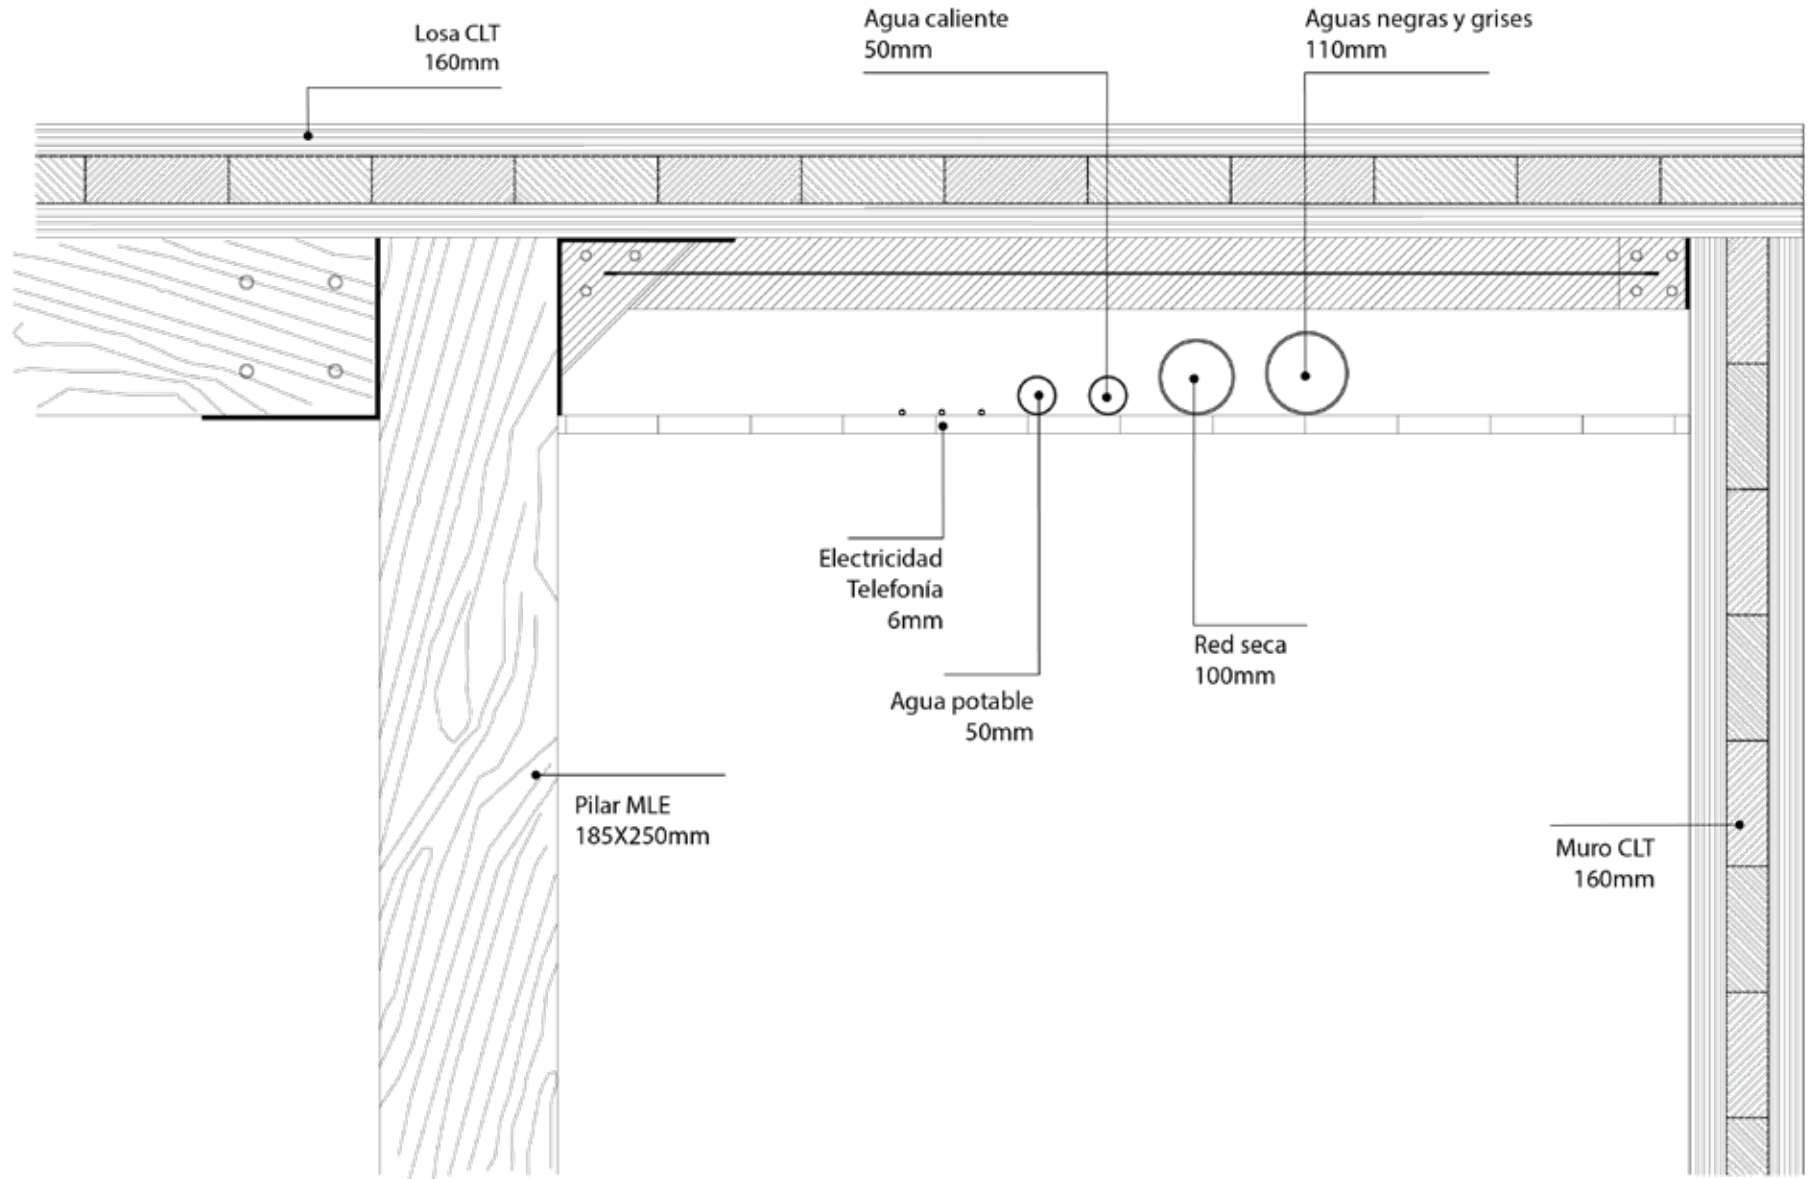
Sección pieza aeero y su relación con ambos sistemas estructurales en madera
